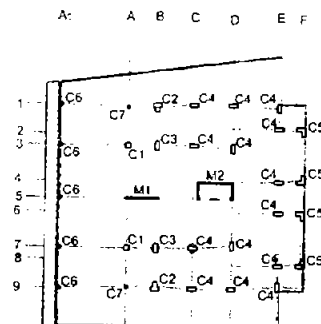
Localización de las columnas en la planta del edificio (Planos de plantas tipo, 2001).
